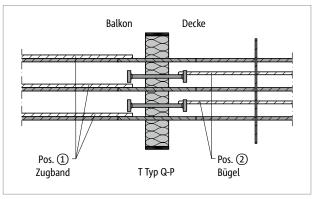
Schöck Isokorb® T Typ QP-Z, QP: Grundriss Loggia
